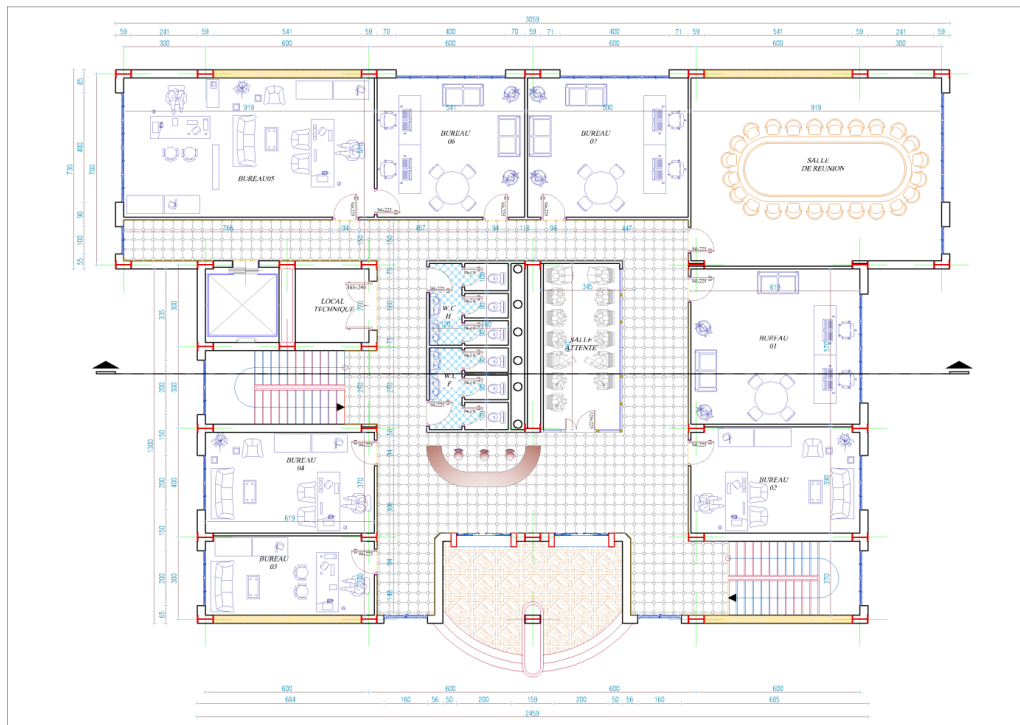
Vue en plan du RDC échelle 1/50.
